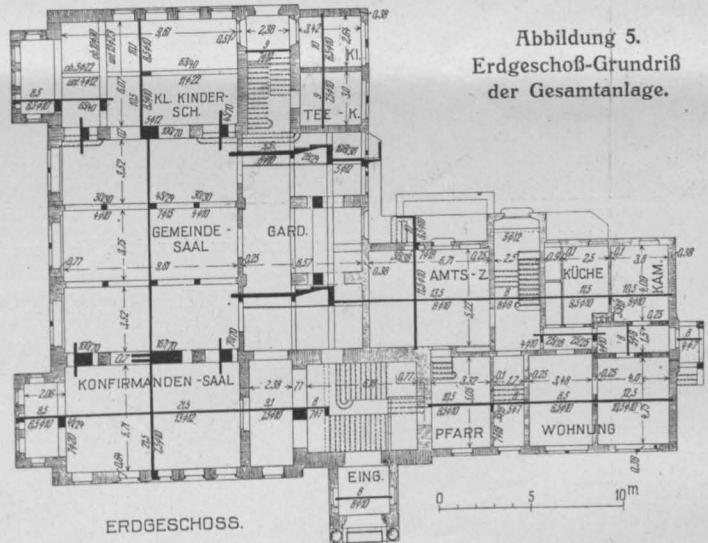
Erdgeschoß-Grundriß der Gesamtanlage.
